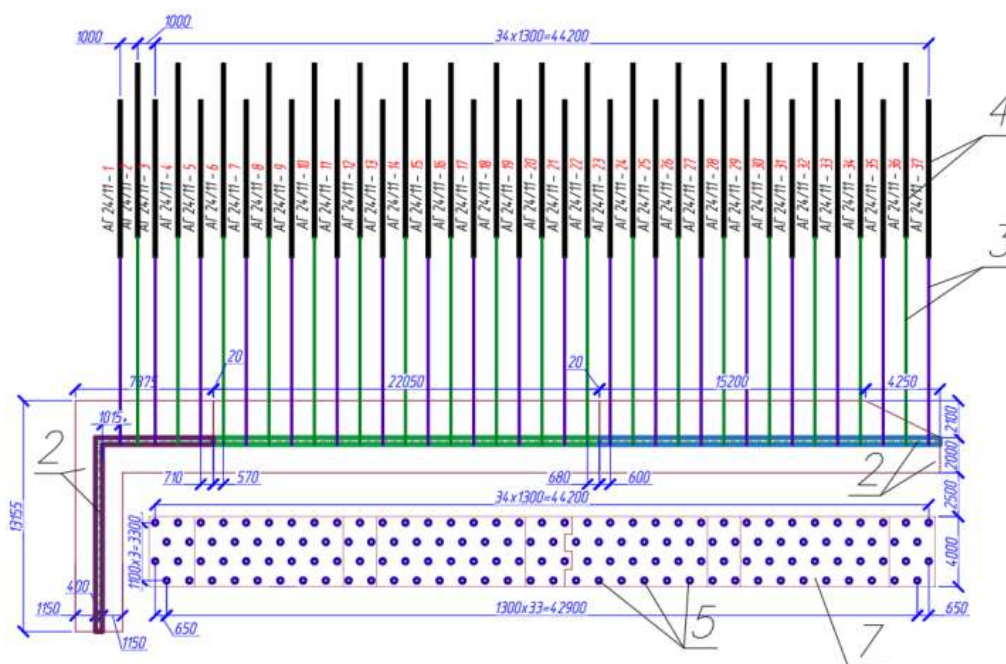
Схема устройства монолитных железобетонных ростверков и диафрагм на завершающем этапе:
